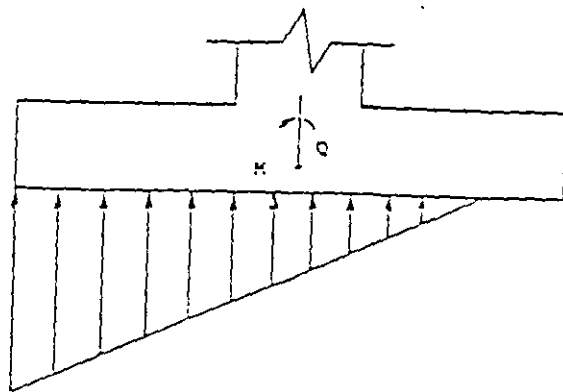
CARACTERÍSTICAS ESTRUCTURALES DE LA ZAPATA (EJEMPLO 5.3)
